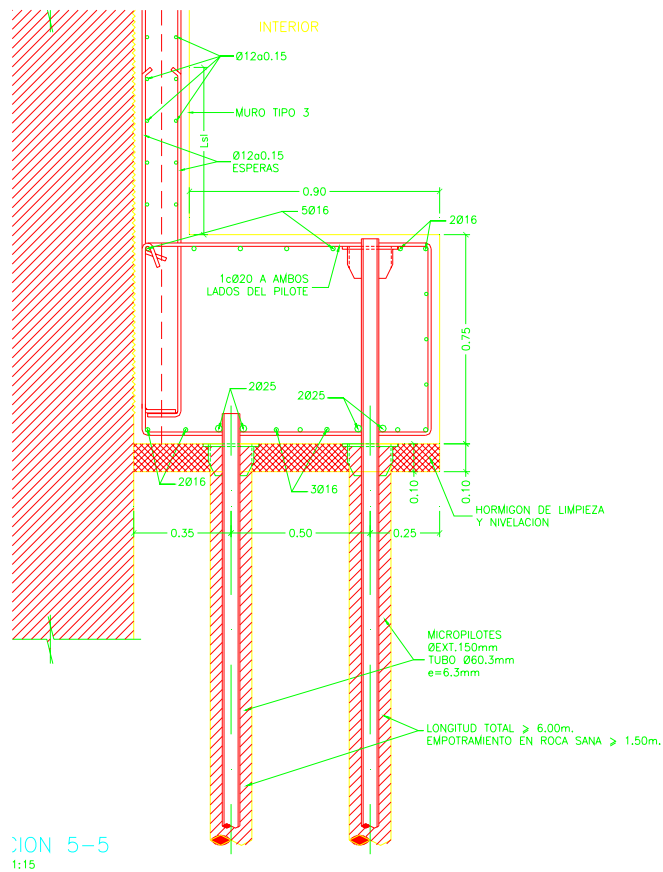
Recalce de la cimentación de los muros mediante un encepado corrido con parejas de pilotes y un muro de hormigón adosado.
